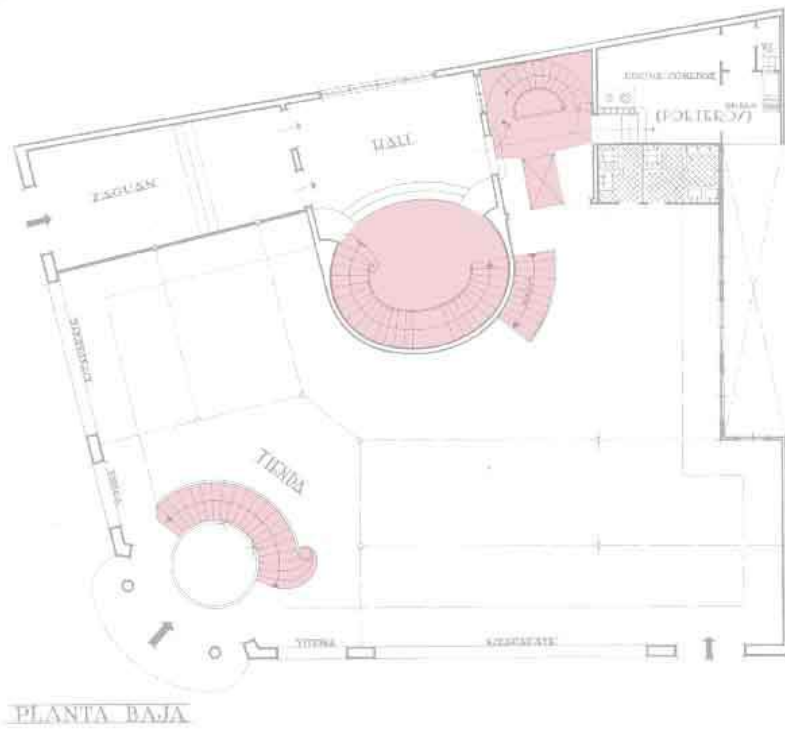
Edificio Legorburo. Planta baja. Proyecto original. Tratamiento digital: Javier Cuartero Colmenero.
